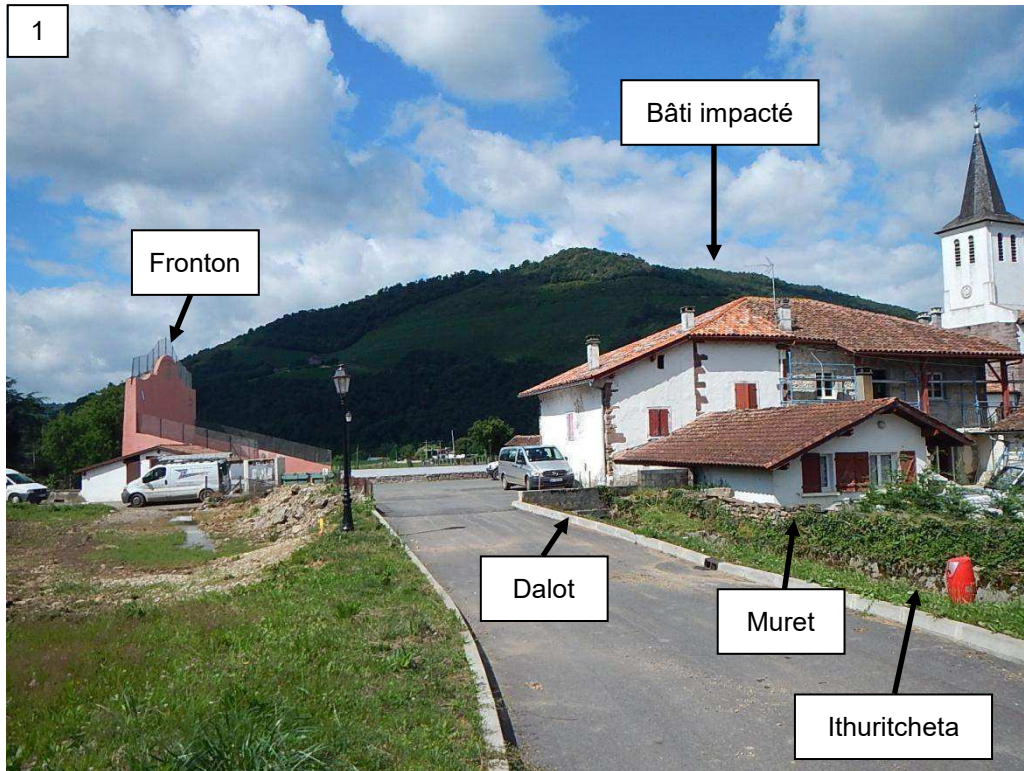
Bâti impacté au bourg : passage sous dalot pas suffisant et débordement par-dessus le muret rive droite et sur la chaussée rive gauche – rue et fronton submergés – repère de crue AIT01
